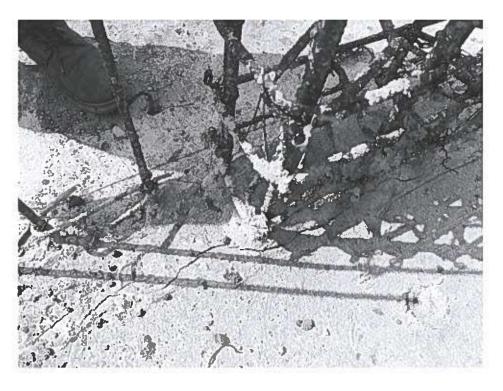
Visualizamos fisuras en la viga de cimentación del bloque N.º 15.
